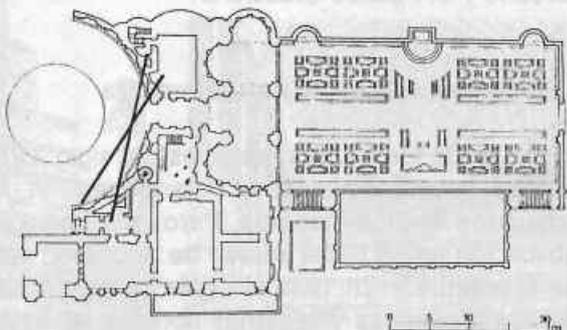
Villa Madama, Rafael. Planta de Greenwood. Peter Murray. "Arquitectura del Renacimiento". Viscontea. Buenos Aires. 1982.
